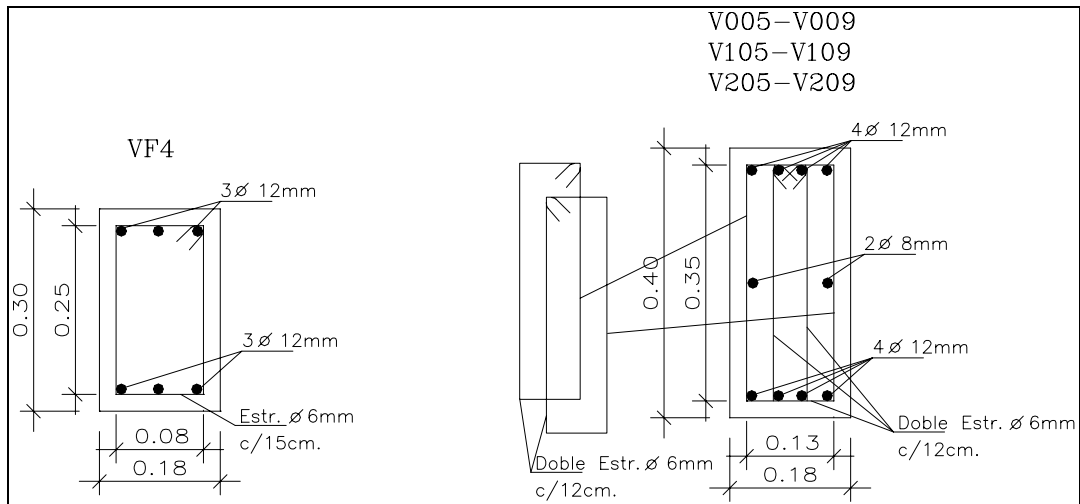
Detalle de disposición de armaduras en vigas de hormigón armado.
